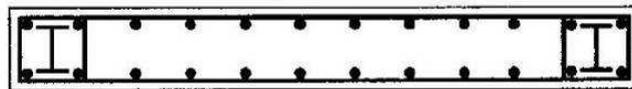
Поперечное сечение железобетонной стены-диафрагмы или пилона с жесткой арматурой из стальных профилей
